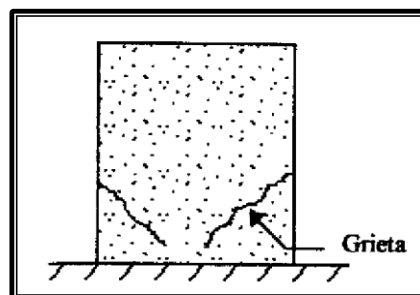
Grietas aproximadamente de 45 Grados en los extremos de la base del muro (Fallas por Cortante)
